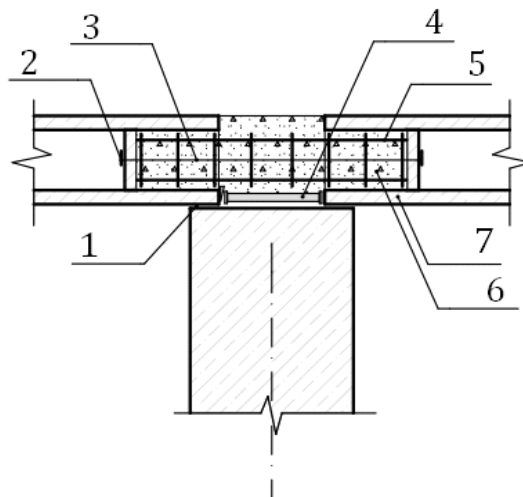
Узел опирания плит перекрытия на вертикальные несущие конструкции: 1 – зазор; 2 – ограничители; 3 – стяжка; 4 – распорка; 5 – арматурный каркас; 6 – замоноличенный стык; 7 – многопустотная плита перекрытия
